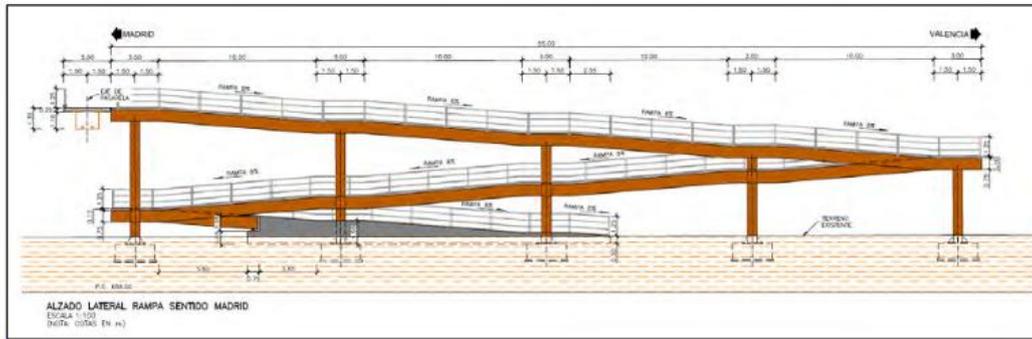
Alzado longitudinal rampa de acceso sentido Madrid. PAS 9+090
